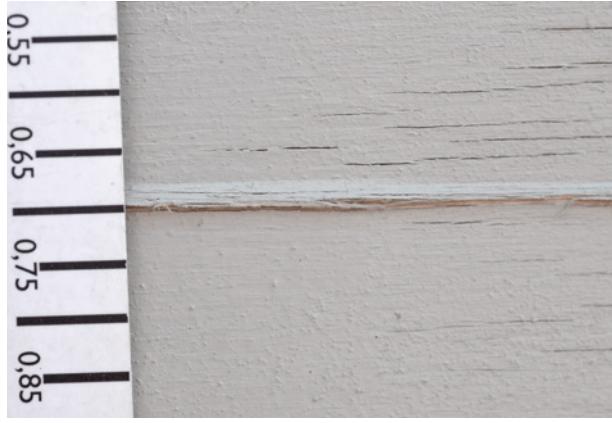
▪ Furnieraufwölbung im Rissbereich
